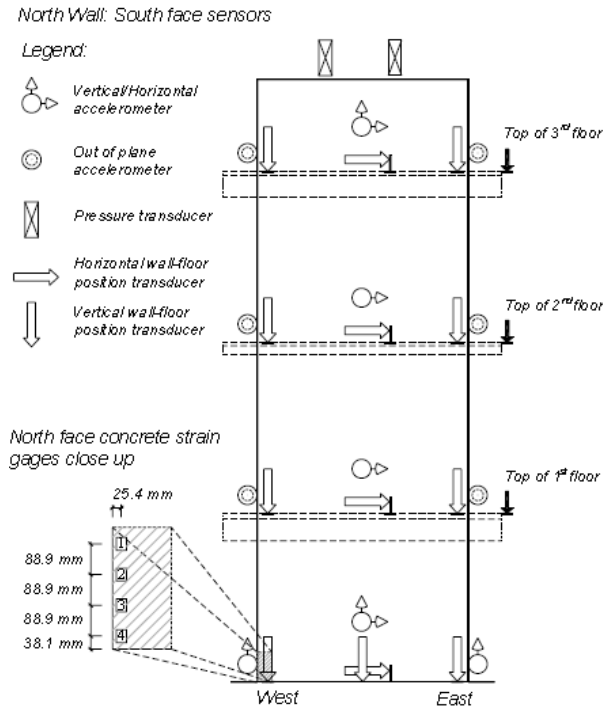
Posizionamento dei sensori sulla parete rocking: accelerometri e trasduttori di pressione e spostamento (Belleri, et al., 2014). / North wall sensor distribution on the rocking wall (Belleri et al., 2014).
